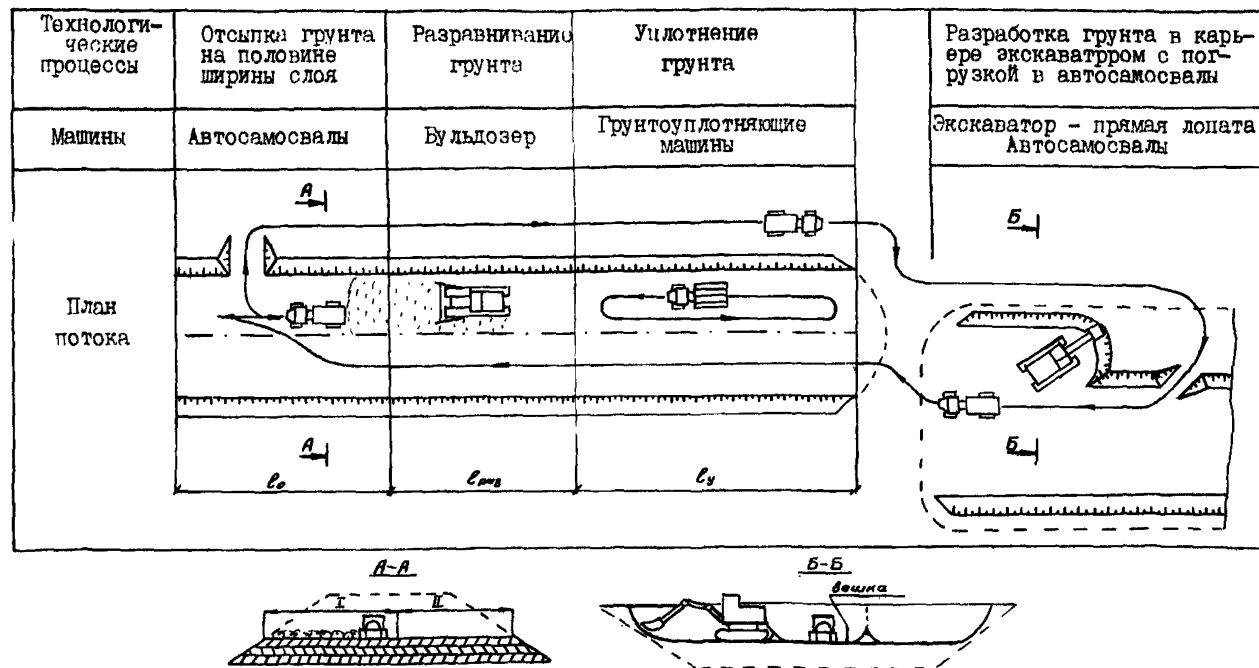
Схема отсыпки насыпи автосамосвалами с разработкой грунта в карьере экскаватором-прямая лопата (с кольцевой ездой автосамосвалами):
